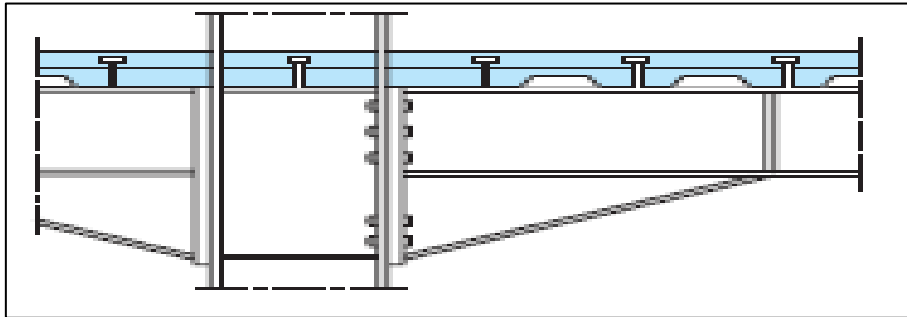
Assemblage de type poutre-poutre de plancher mixte
